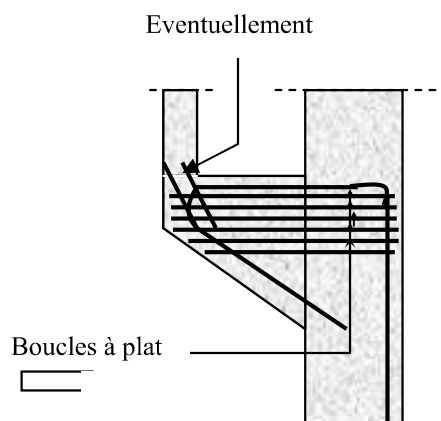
Disposition de ferrailage pour éviter la dégradation du corbeau.
